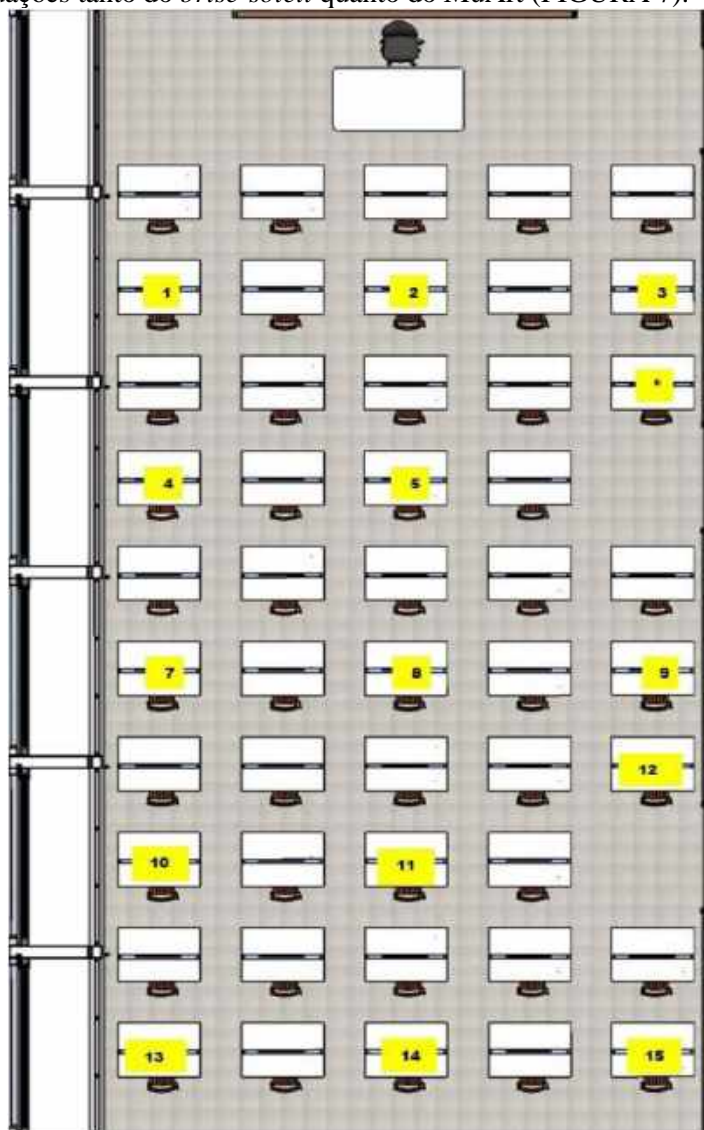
Planta Baixa com layout da sala e mesas medidas no experimento.
